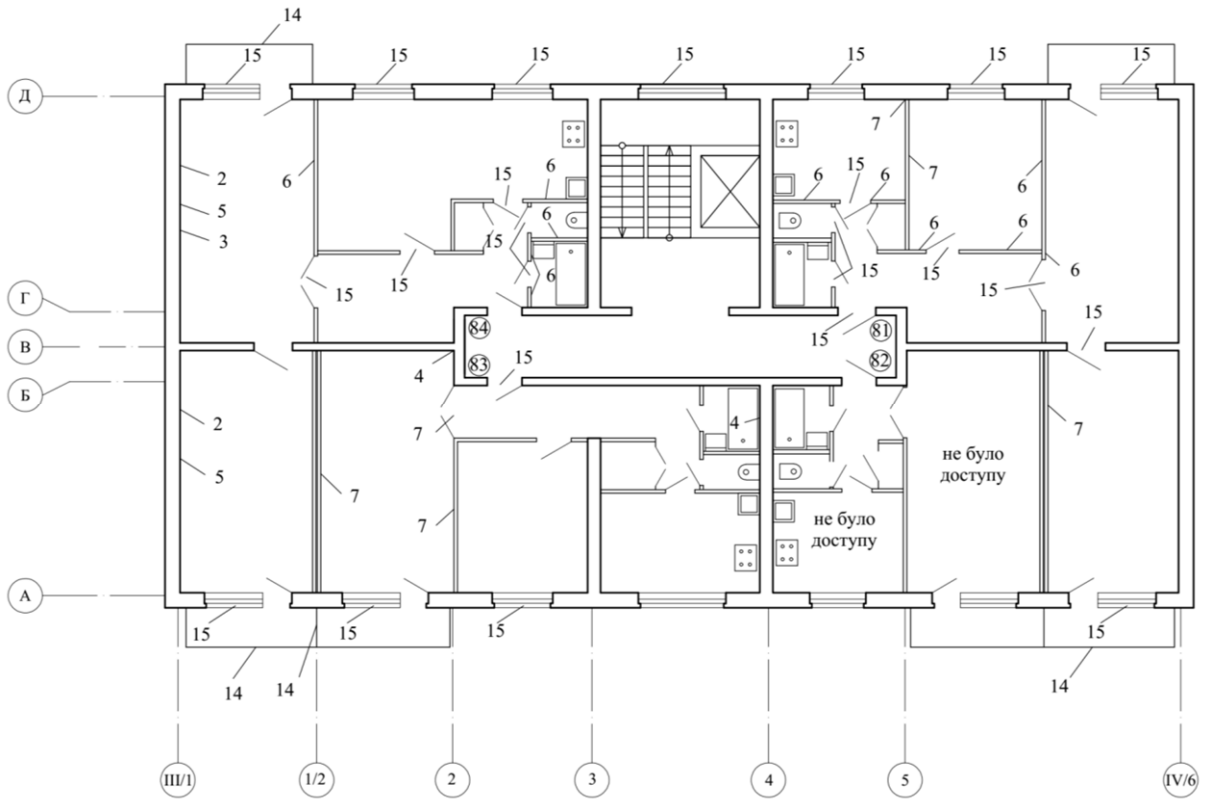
План третього поверху блок-секції № 3 будівлі
